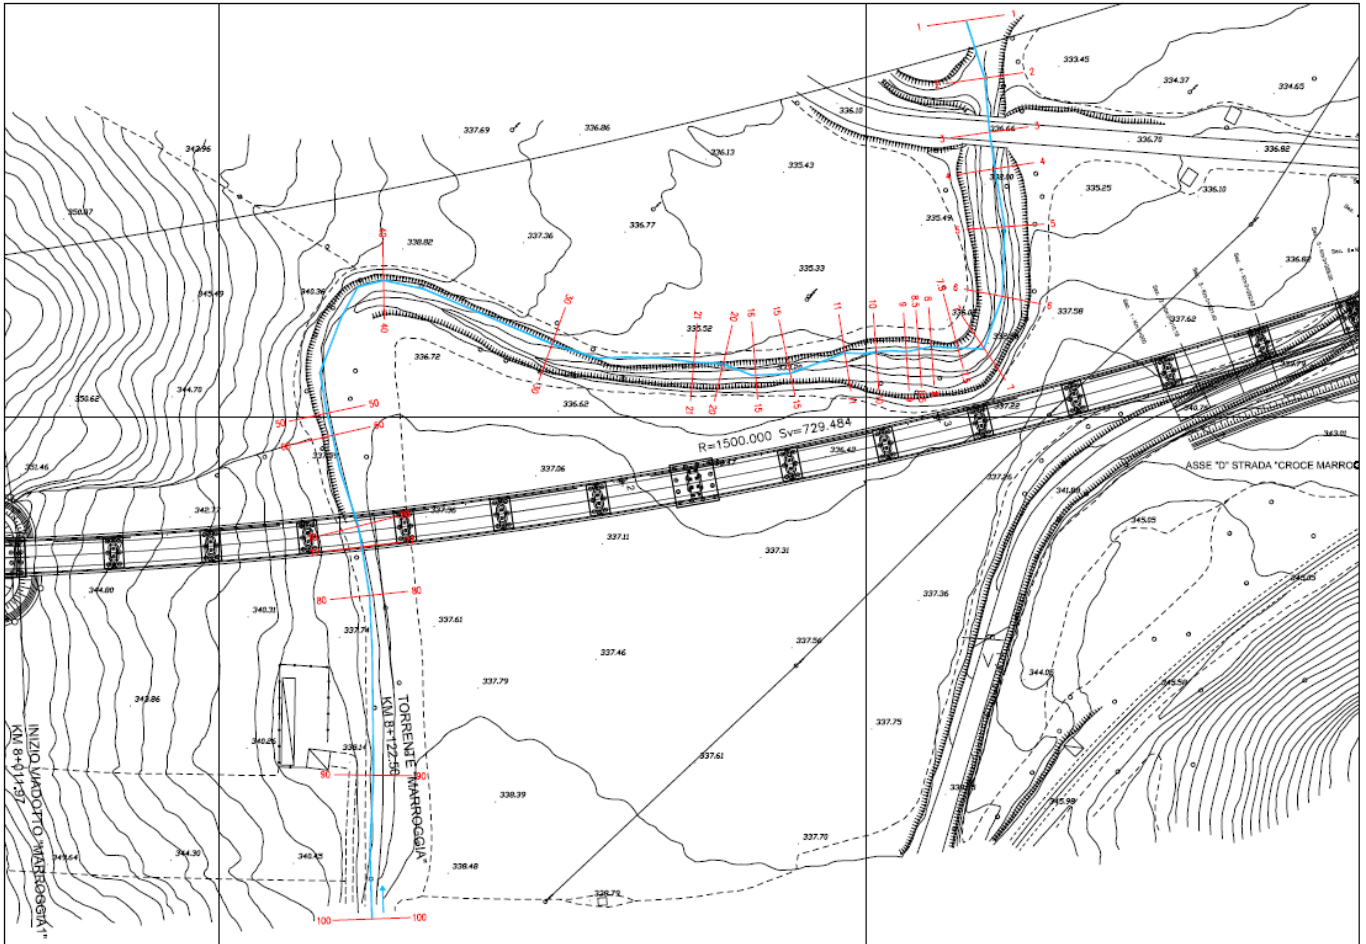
Planimetria e sezioni trasversali d'alveo.
